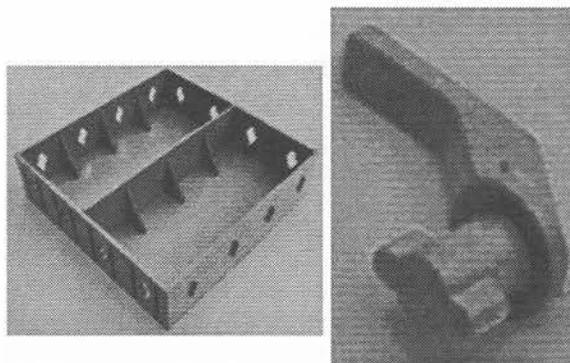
Detalhe da placa e chaveta para fixação (Fonte: Betonform).
